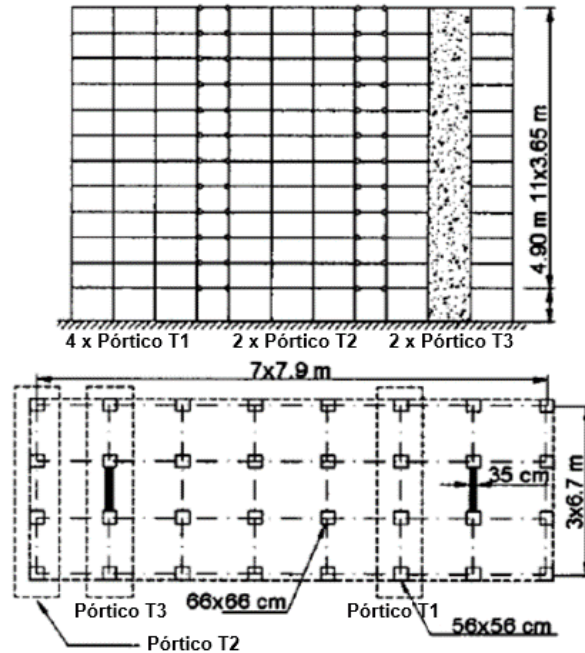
Planta y modelo análisis de edificio concreto reforzado de 12 pisos
